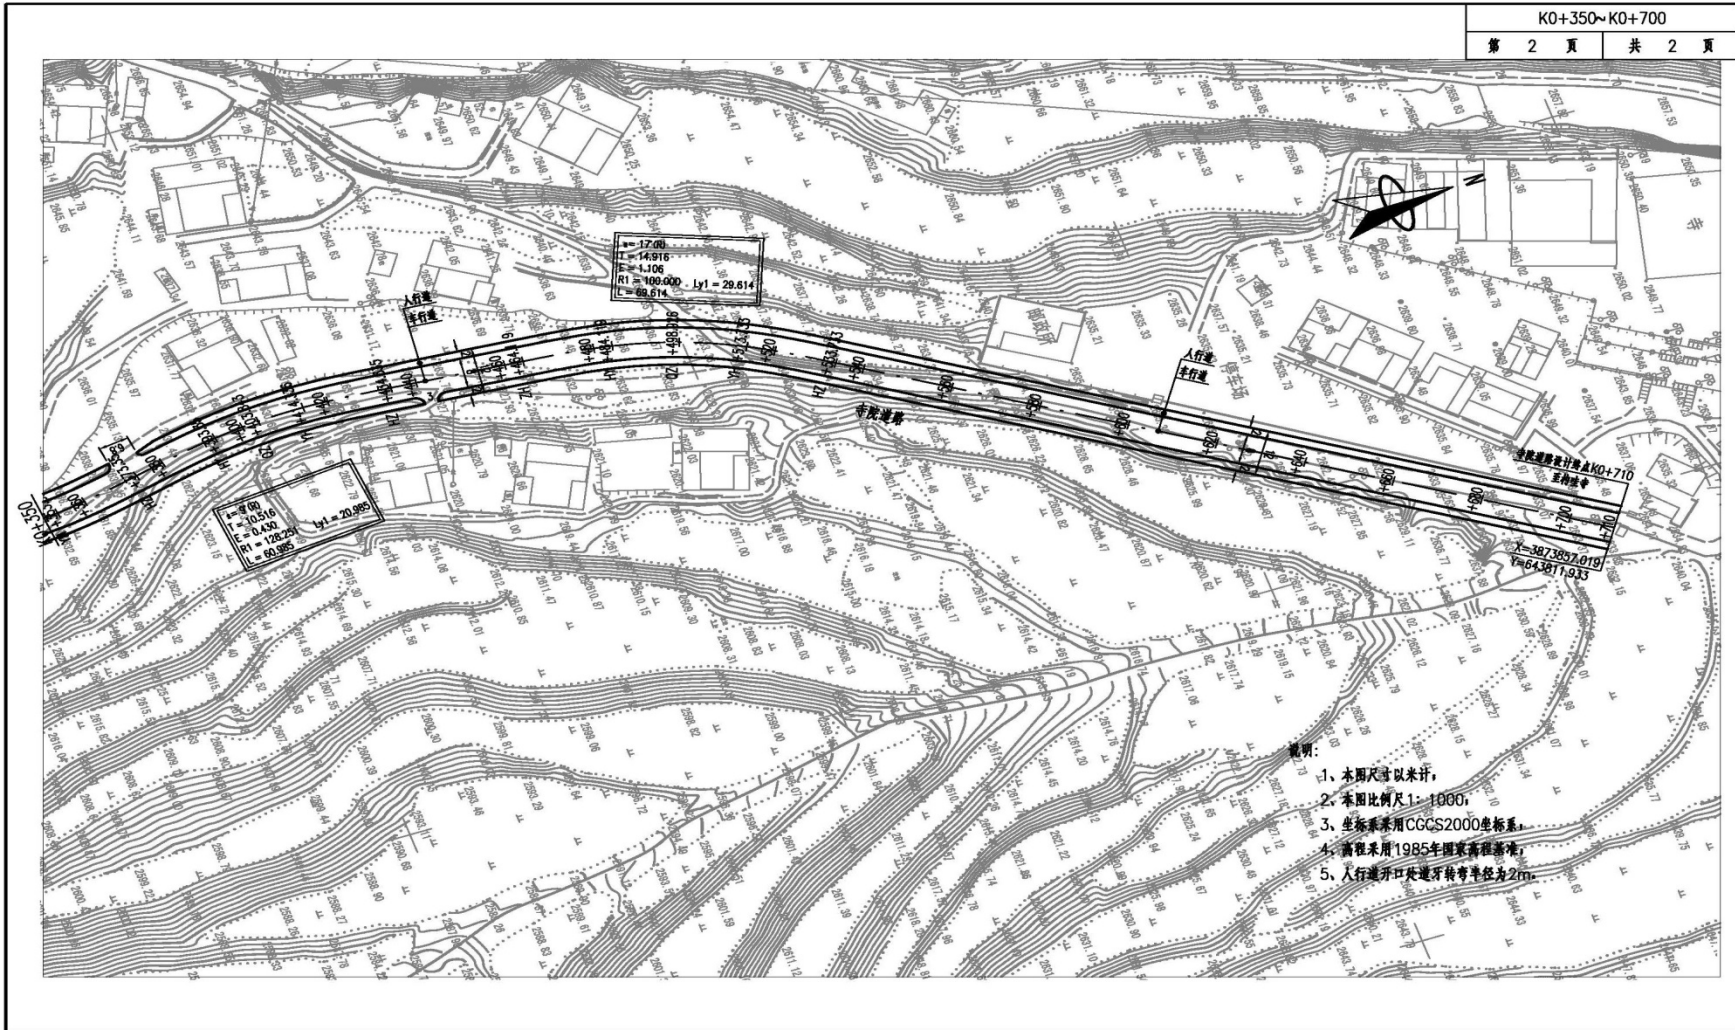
寺院道路 K0+350- K0+710 段平面布置图
